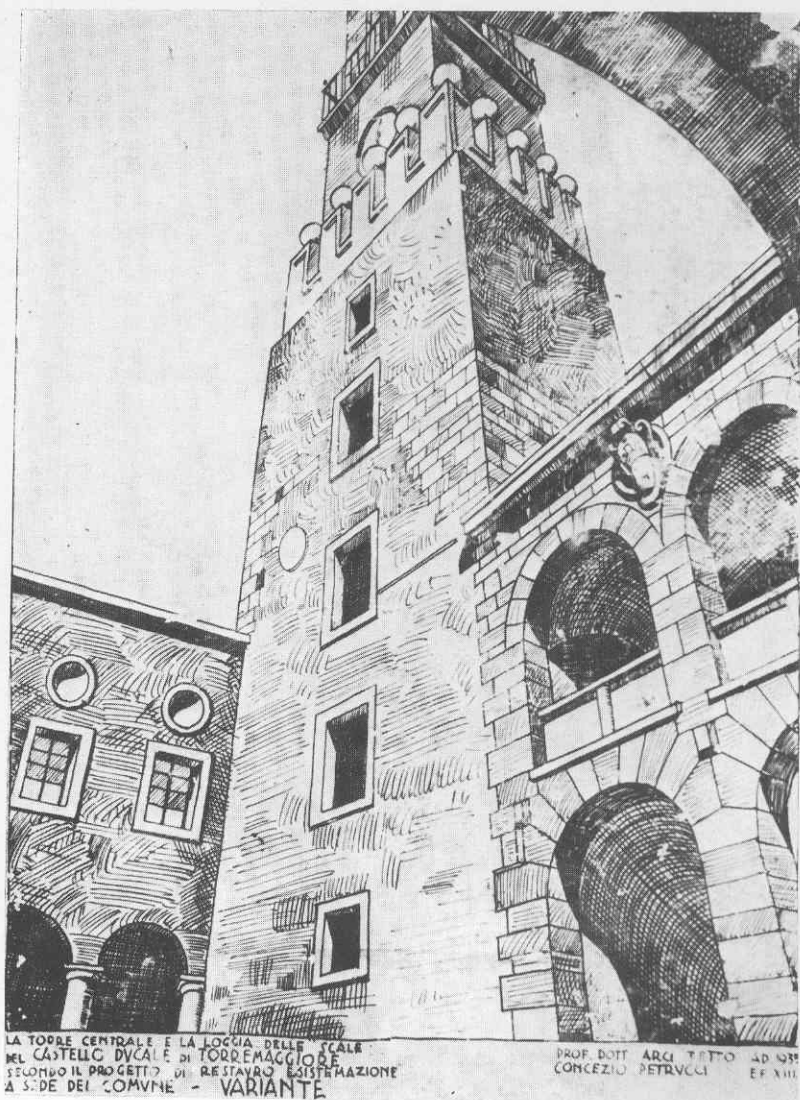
Fotografia della TORRE QUADRA Centrale, con la loggia dello Scalone (ex progetto dell'architetto C. PETRUCCI).
